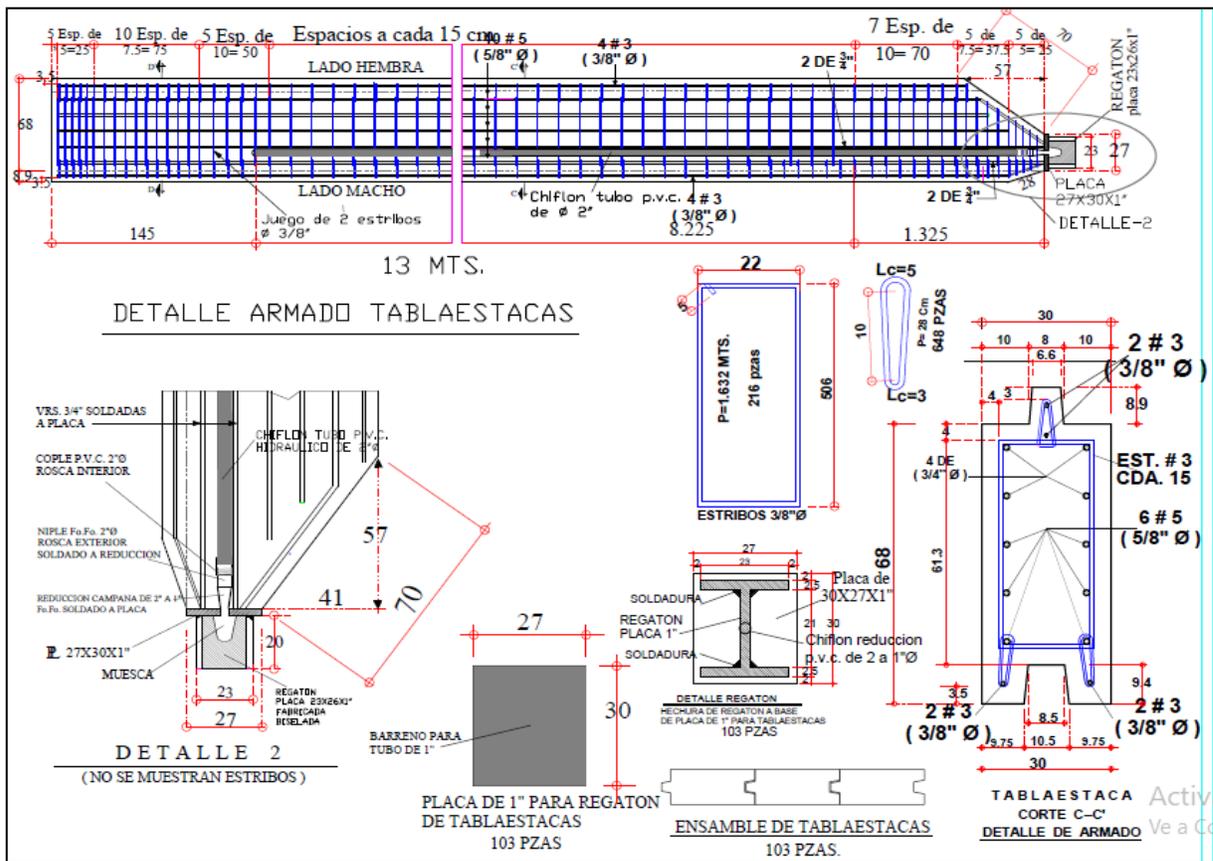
Foso de Entrada, armado de Pilas y Tablaestacas (Plano Ejecutivo # 4).
